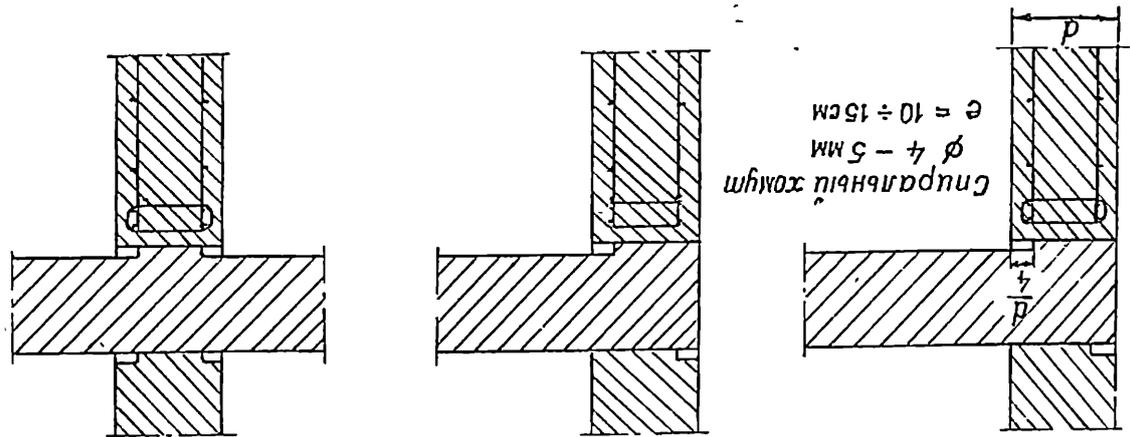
7. Спиральные хомуты в балках-стенках для обеспечения прочности краевых участков
